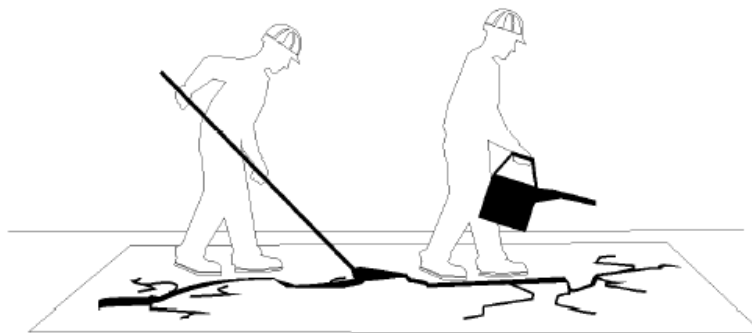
Relleno de grietas con CA Fuente:
